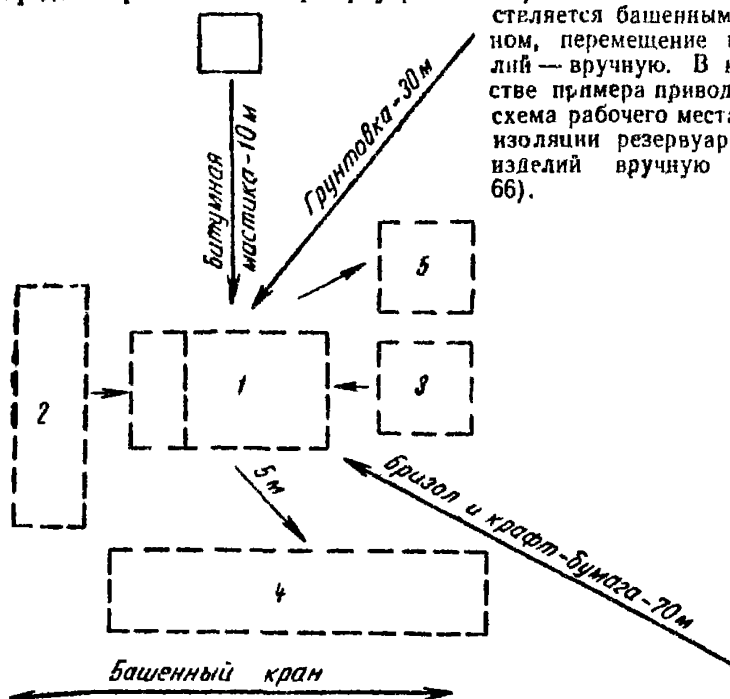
Схема рабочего места для изоляции резервуаров и изделий вручную
